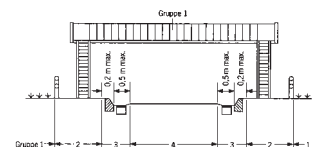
Typischer Querschnitt einer Straße mit Darstellung einiger Gruppen von Einbaustellen
